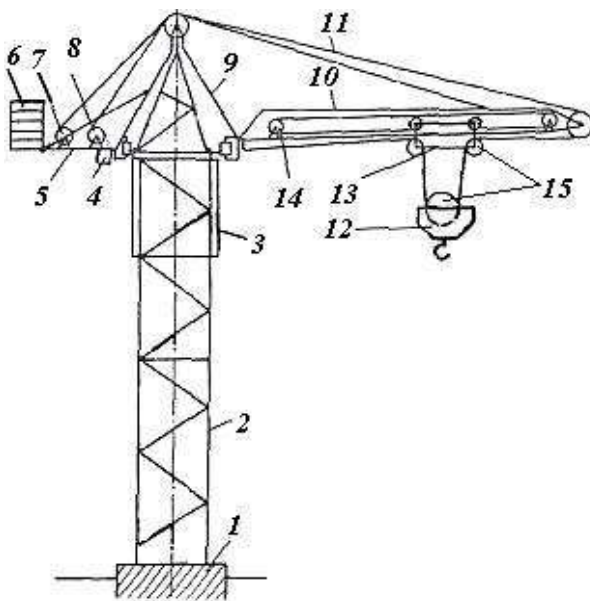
Схема баштового крана з неповоротною баштою:
